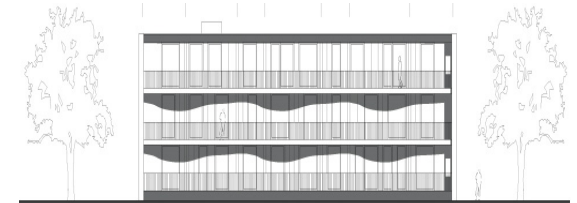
Prospetto sud; Fonte: www.giesarchitekten.de;
